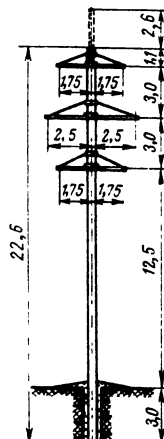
Железобетонная промежуточная двухцепная опора ВЛ 35 кВ
